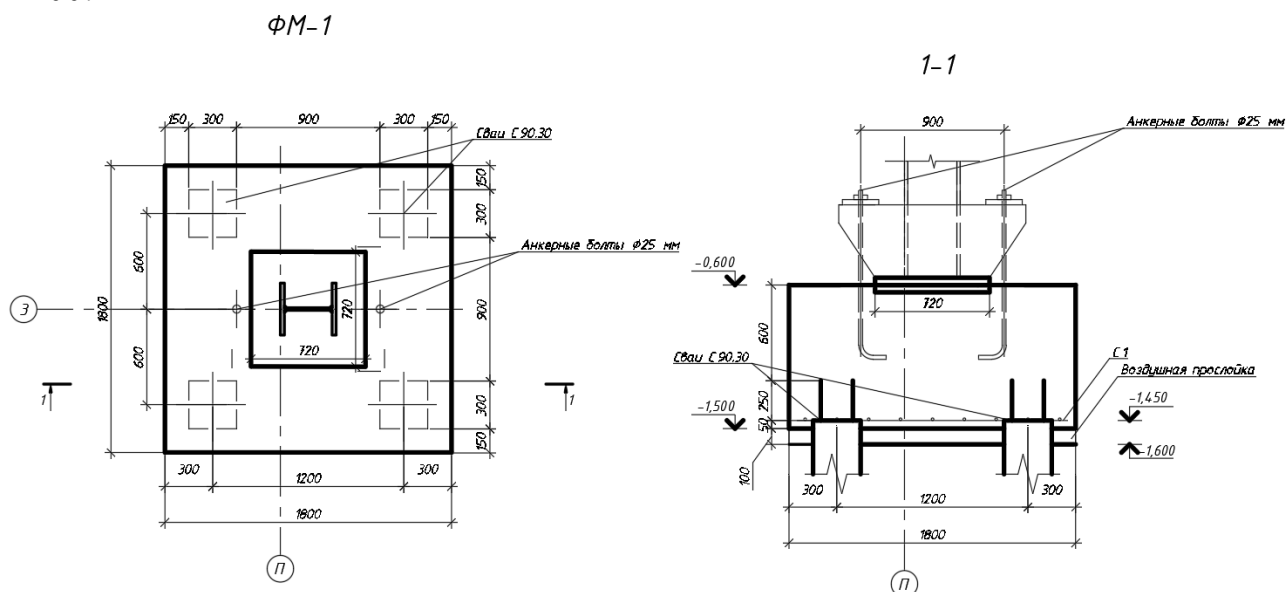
Конструирование свайного куста под колонну К-1
